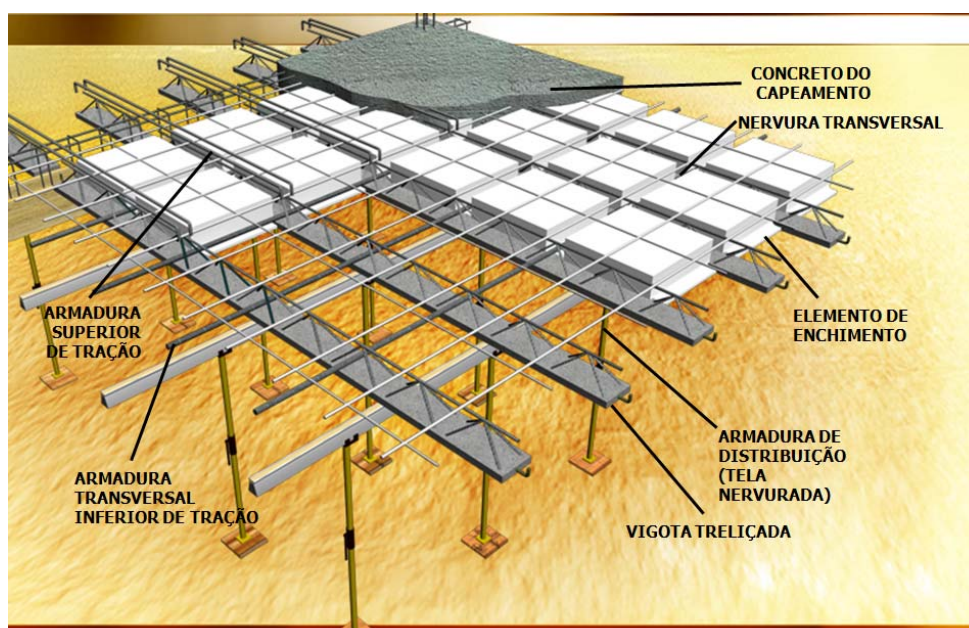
Detalhe da laje nervurada trelçada bidirecional
